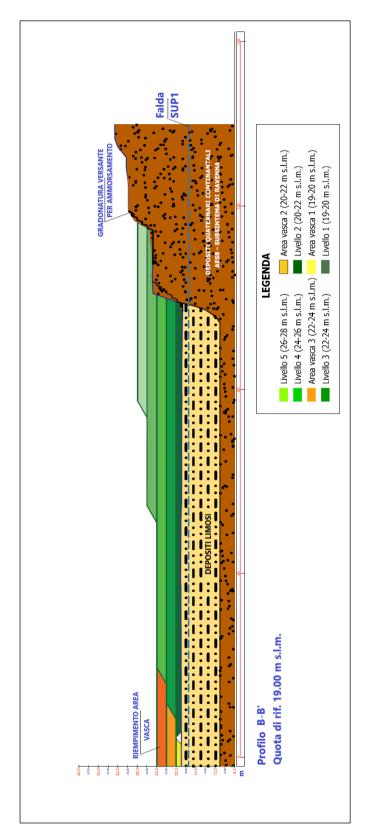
Sezione B- B' sul versante ovest di Cava Olmi
